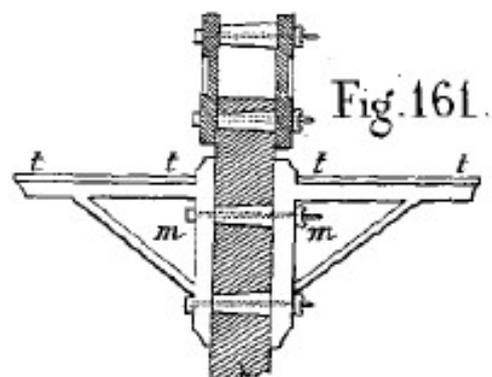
Sección de un cajón. Rebolledo, Construcción general. Fig. 161
